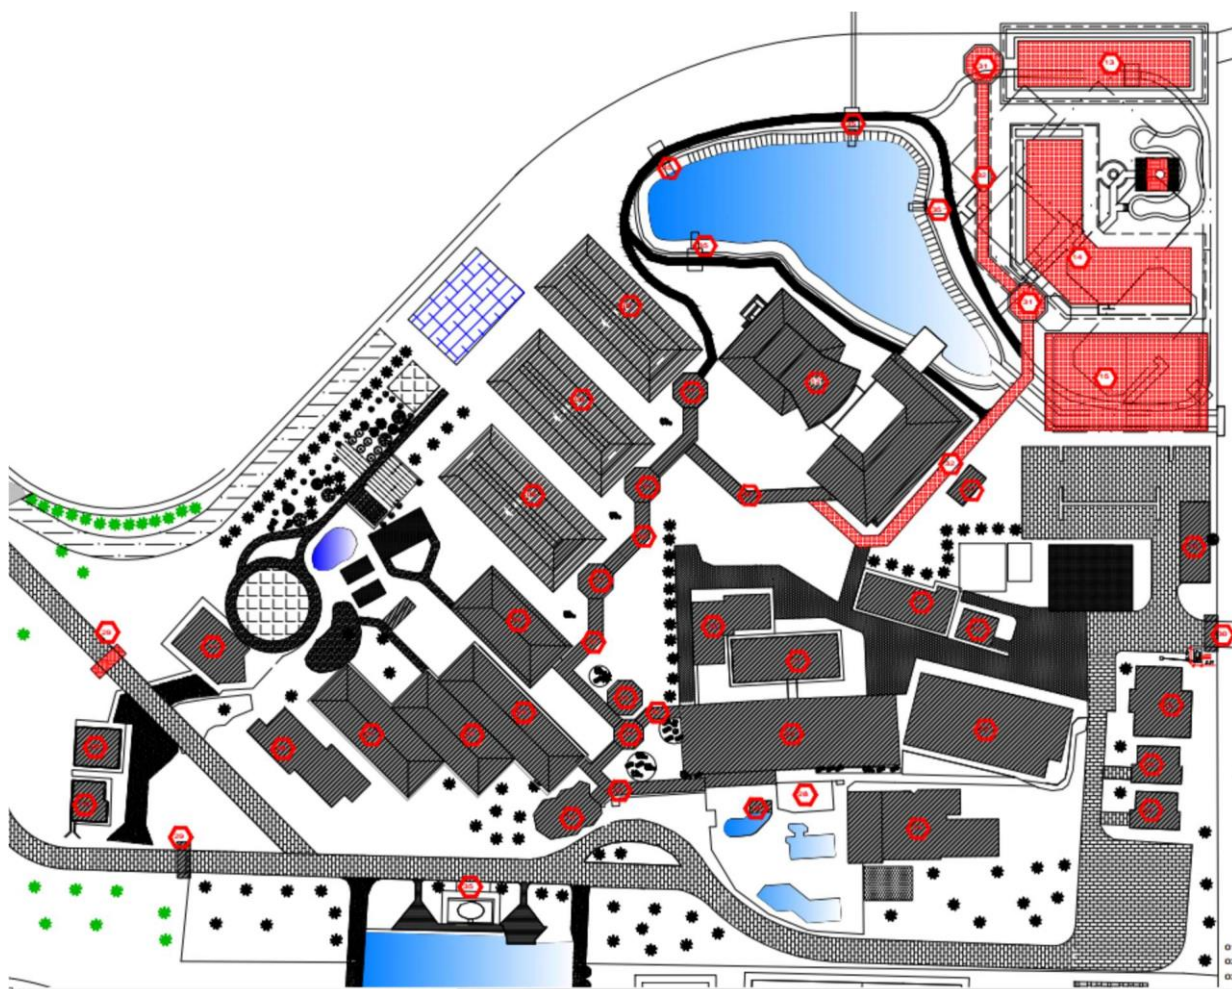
Planta de Implantação Hotel Sesc Porto Cercado
